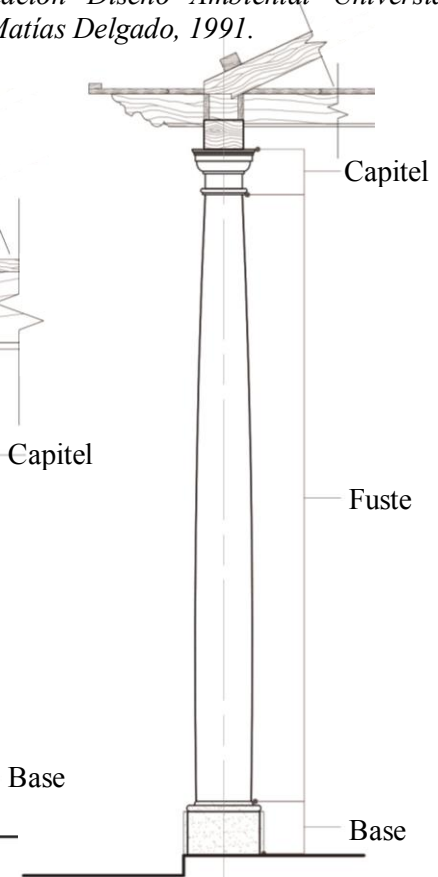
Columna Toscana existente en el corredor Norte y Oeste.
